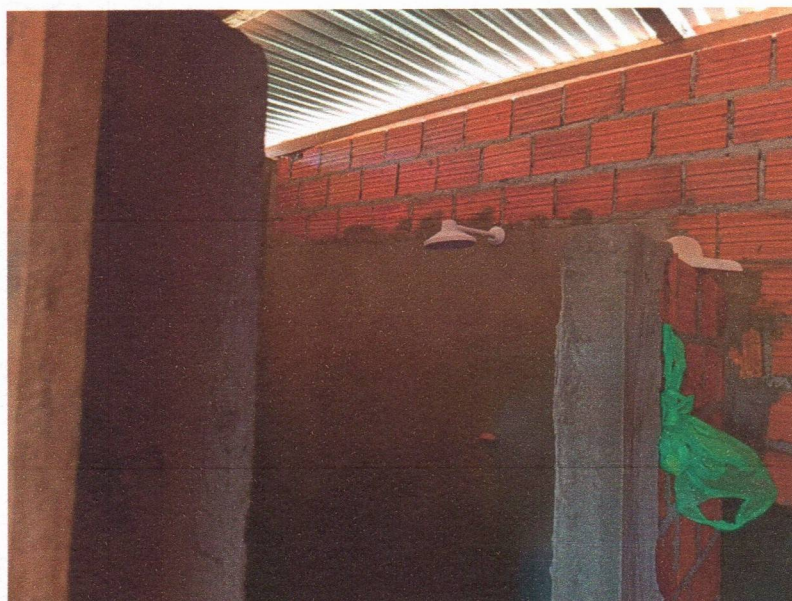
execução de chuveiro no vestiário em canteiro de obras
